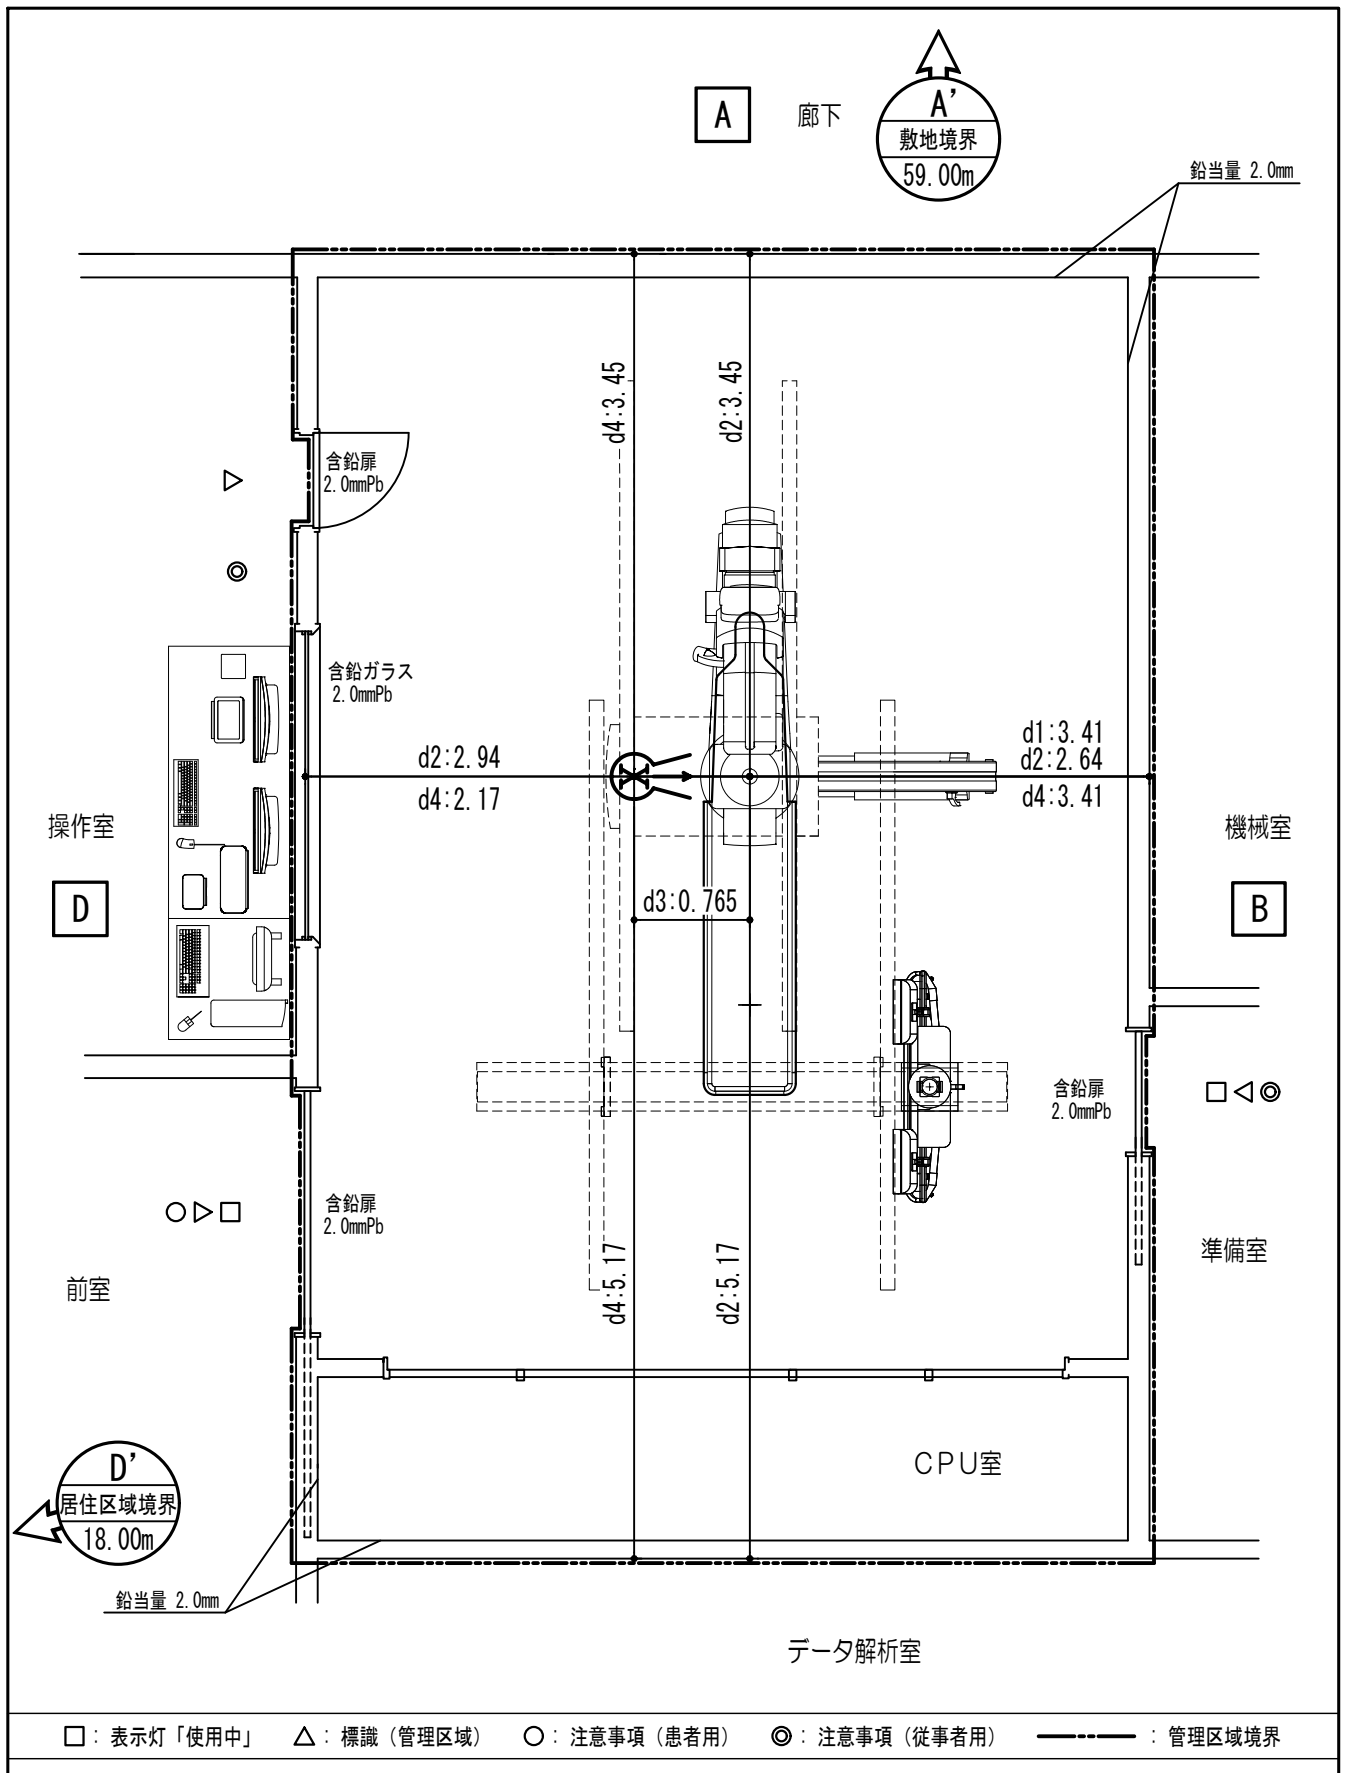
循環器用X線診断装置 天井吊管球 透視・撮影 平面図
